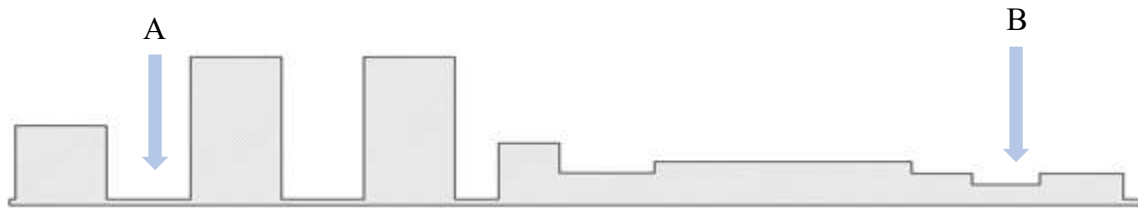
Alzado conceptual perfil norte. Acera norte Eje 10 Sur Copilco. Fuente: Elaboración propia.
